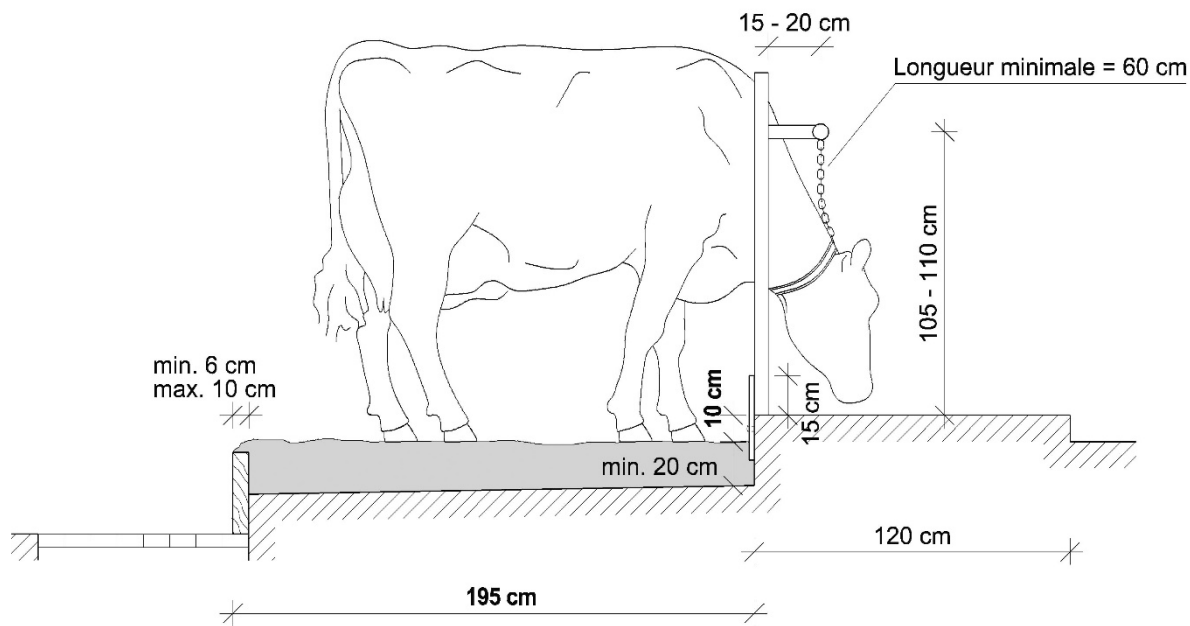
matelas chaux-paille avec pose d'une planche d'arrêt (variante B).
